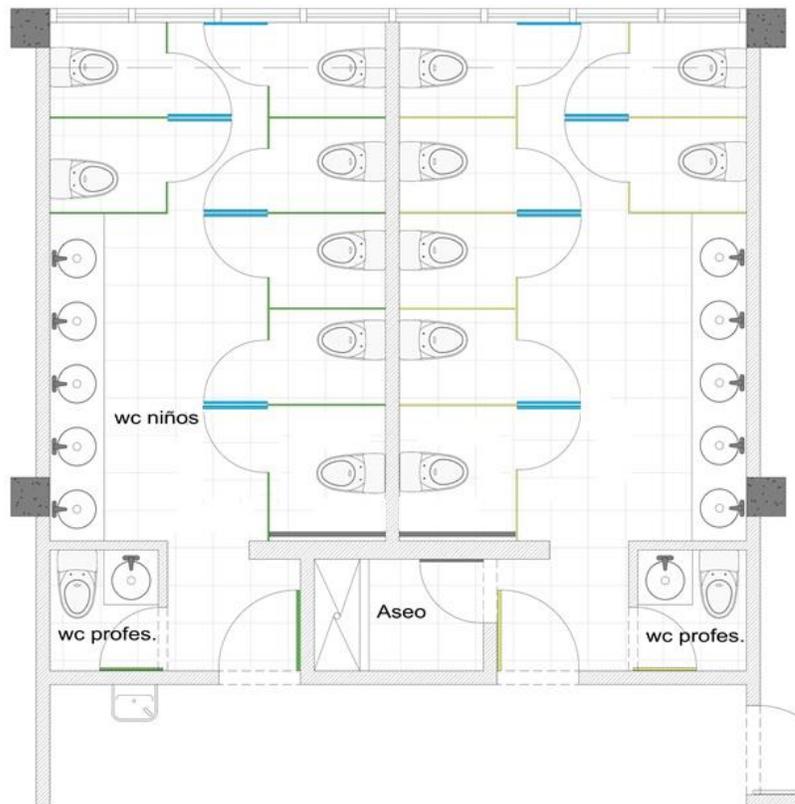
Plano baños segundo piso colegio Gimnasio Superior
